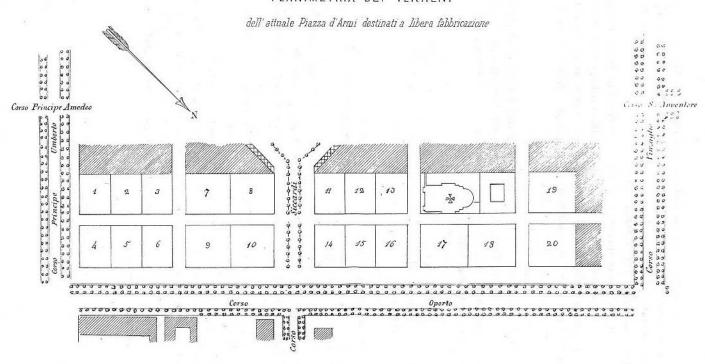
Planimetria dei terreni della Piazza d'Armi.
